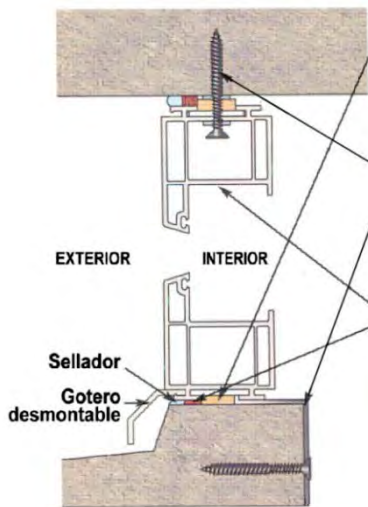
FIJACIONES EN TRAVESAÑOS (Manguetas horizontales)
